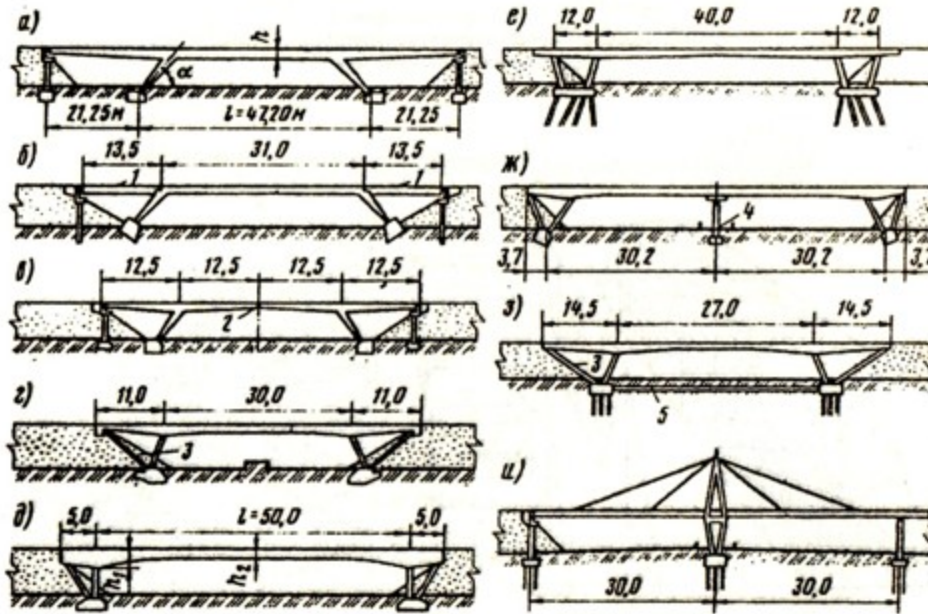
Схемы железобетонных путепроводов рамной и комбинированной систем:
